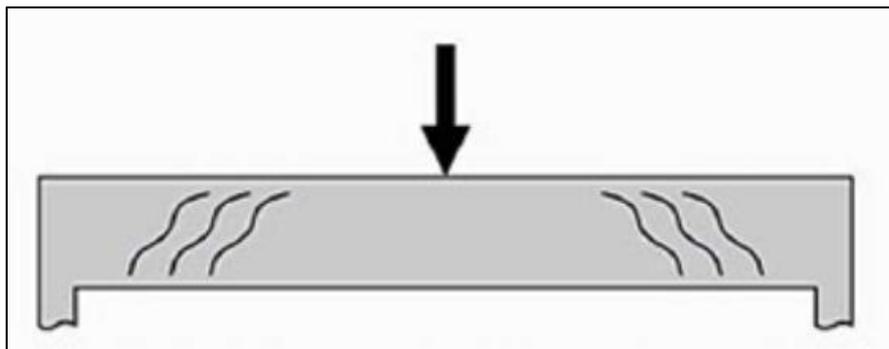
Fissuras de cisalhamento em vigas solicitadas à flexão.
